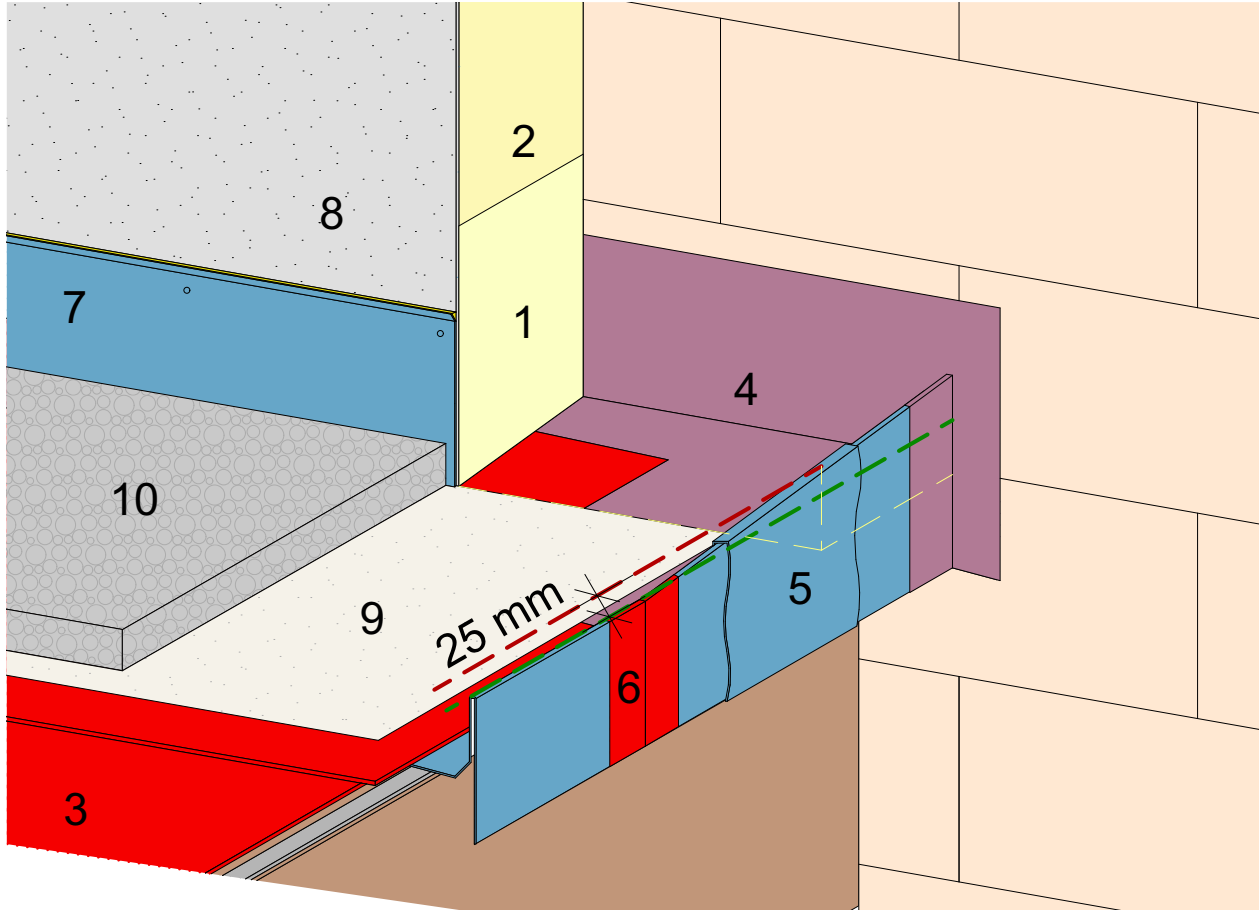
Raccordement au mur Variante 1 (détail 1.5)
